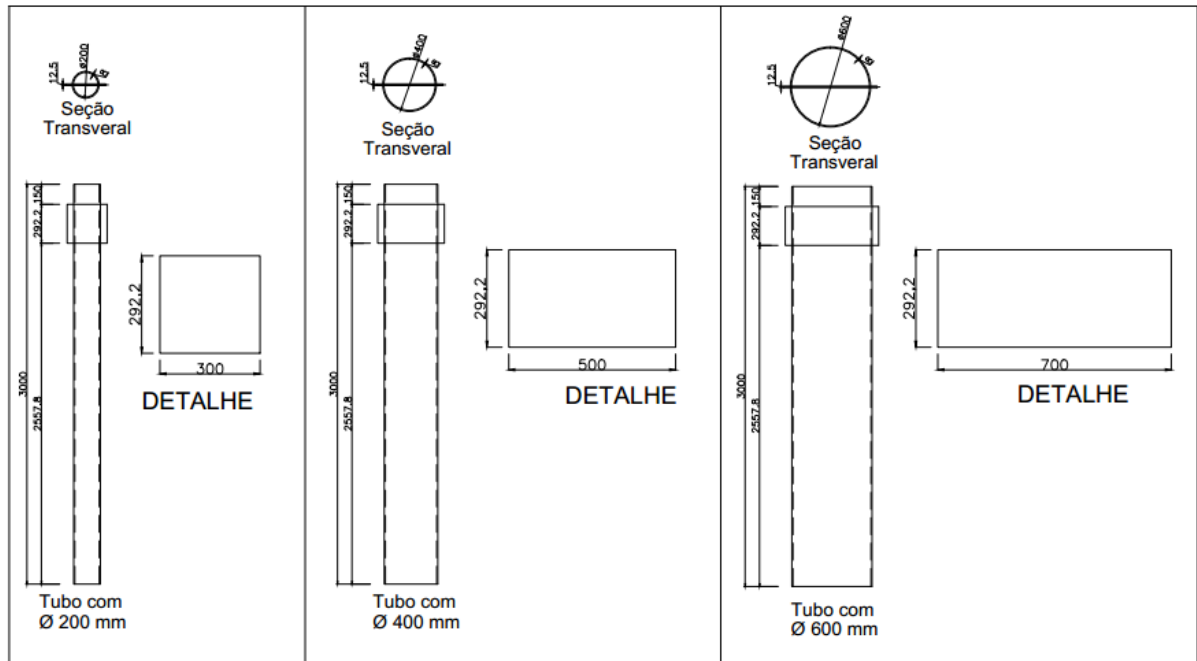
Detalhamento dos Pilares com a Chapa Passante
